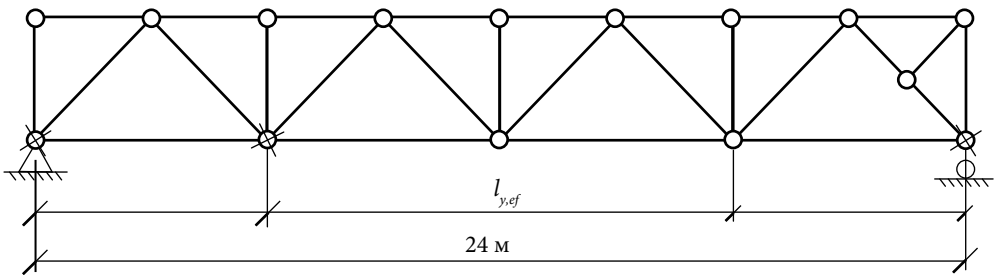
Схема расположения точек крепления связей по нижнему поясу фермы: × — точки крепления связей по нижнему поясу фермы
